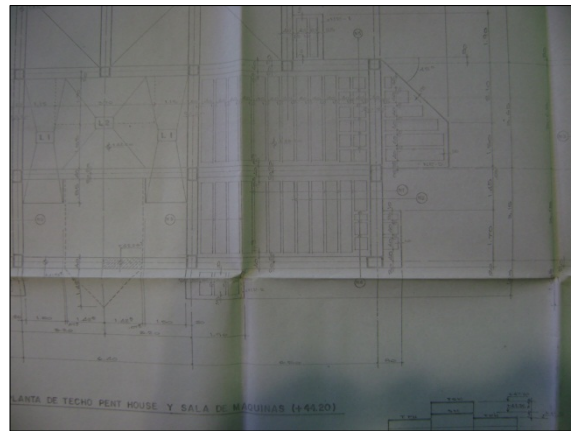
Fotografía de Plano de Estructura de Losas de Planta Tipo
